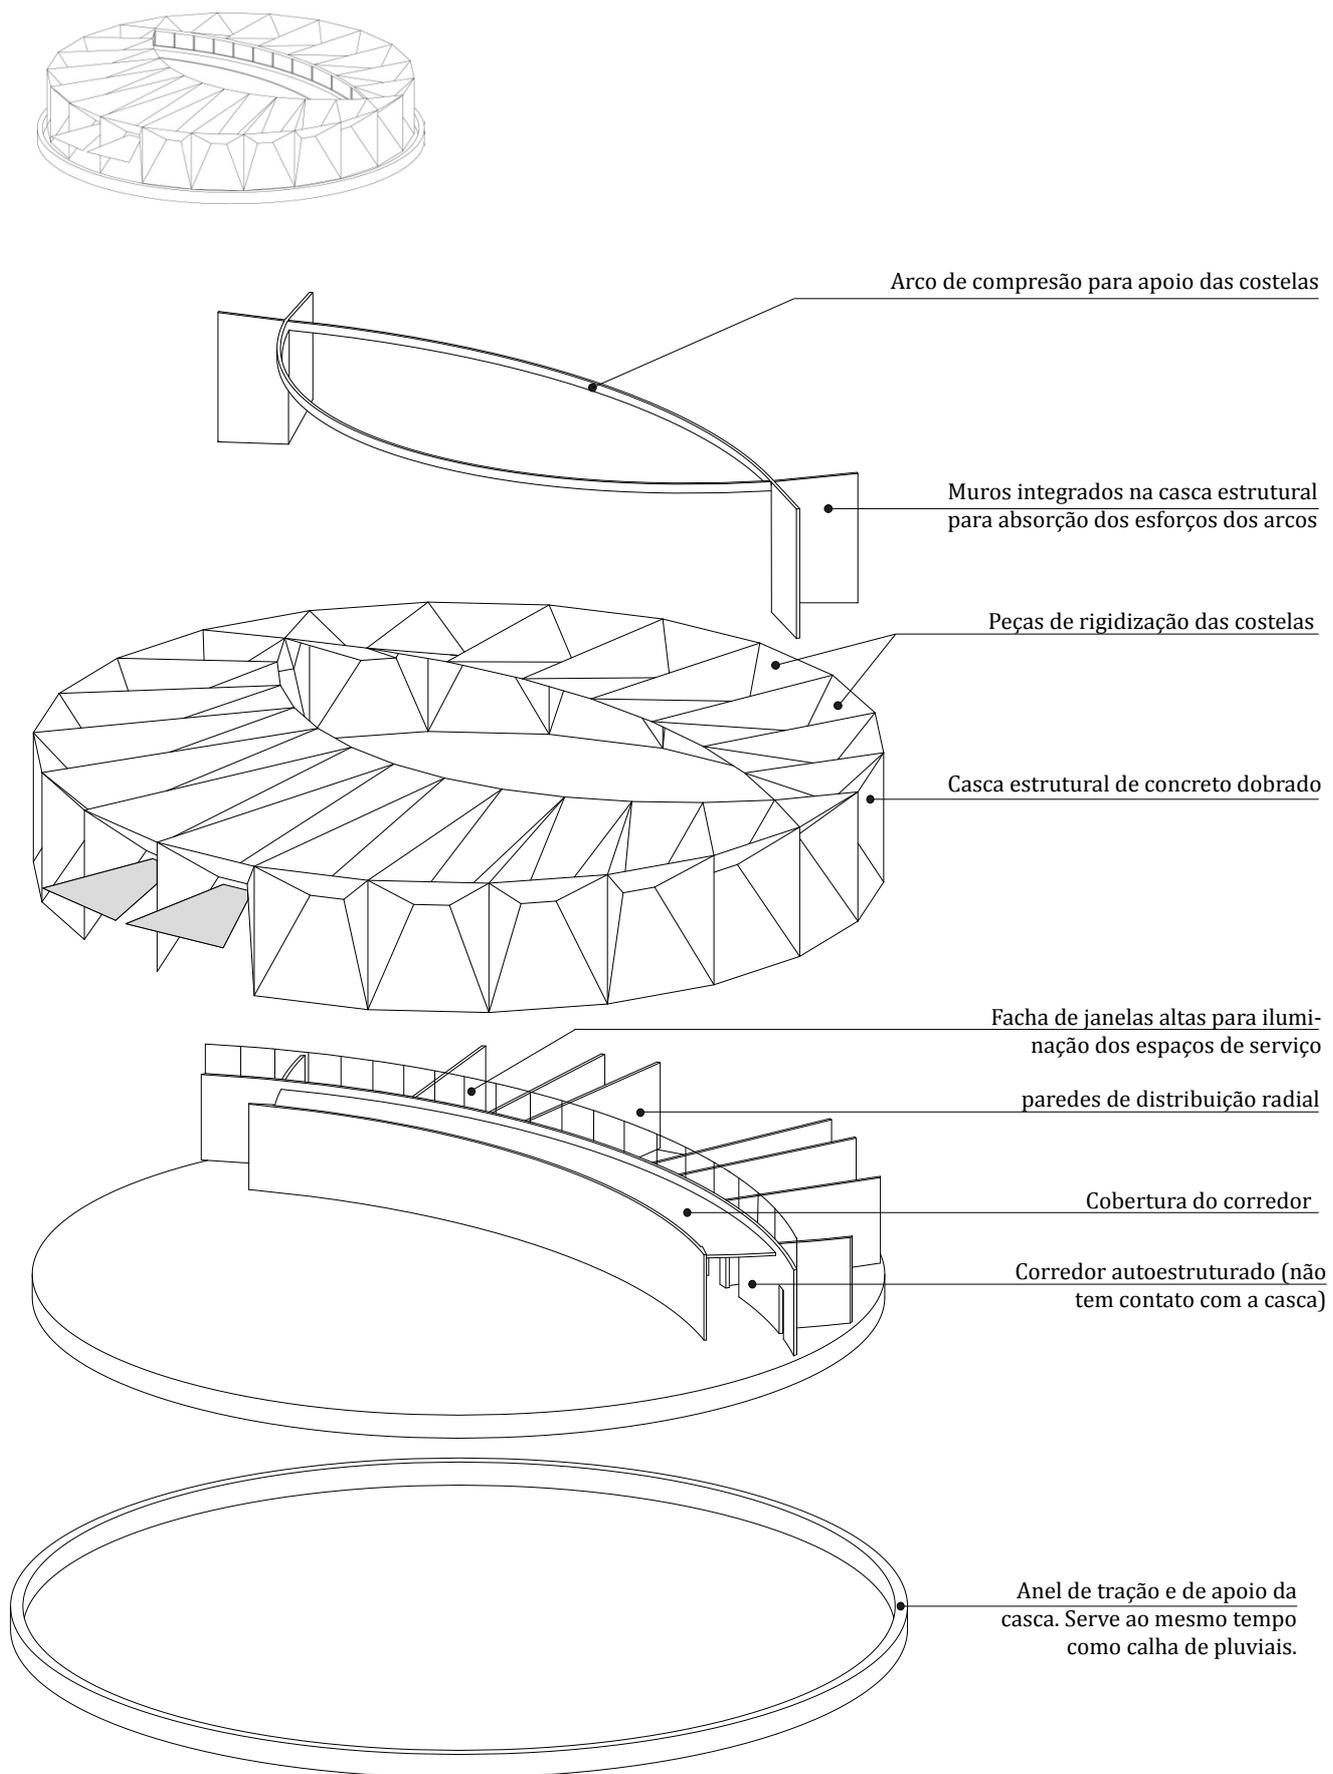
Axonometria das partes estruturais do Pavilhão do Morro da Viúva
